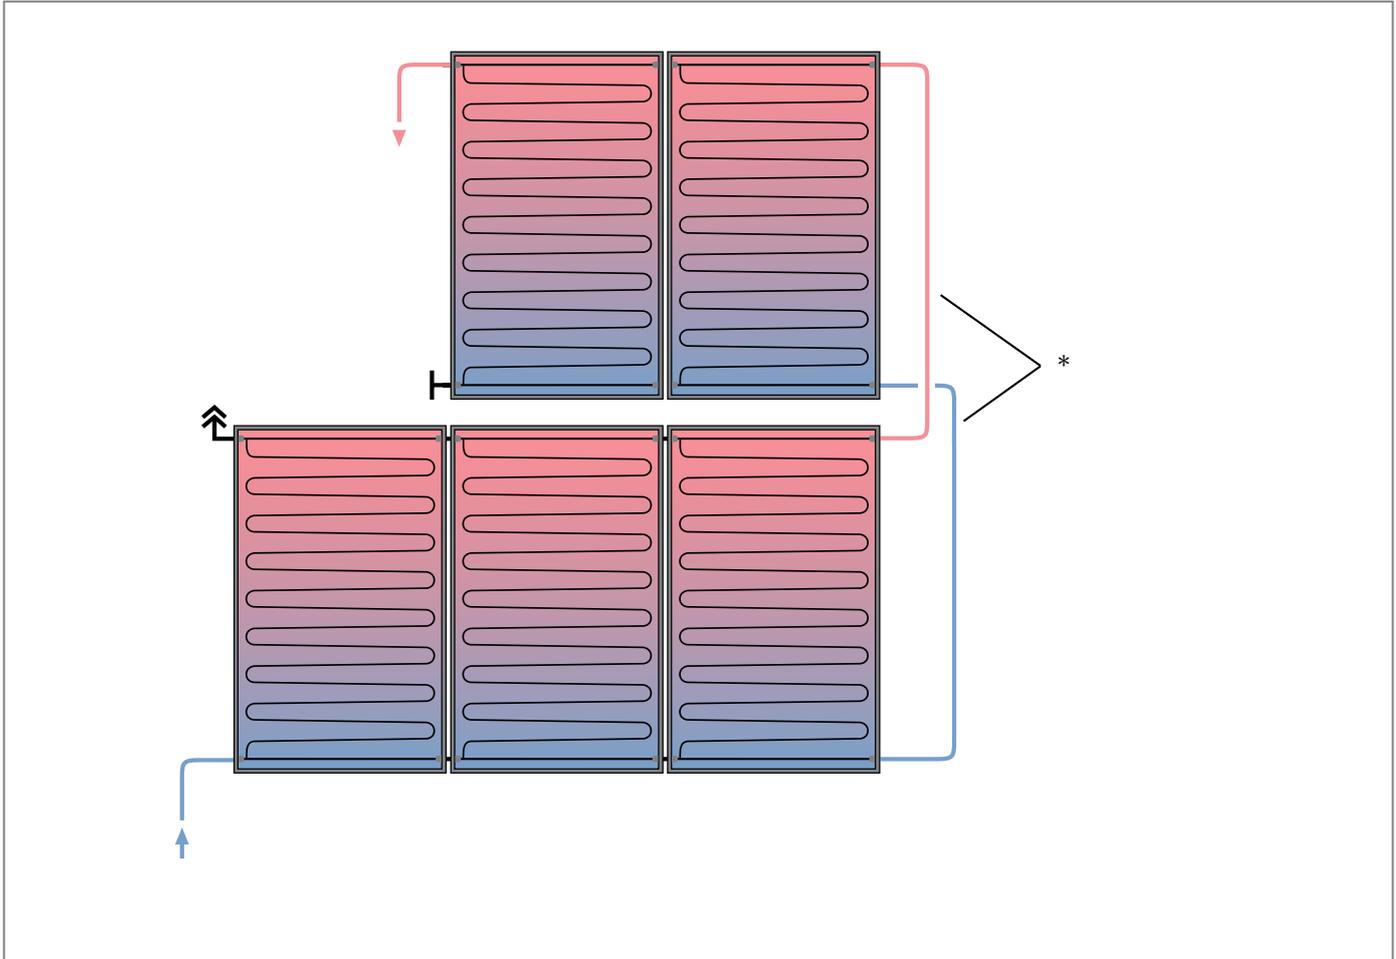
Schema dei collegamenti con 5 collettori su due file e tubazione sul posto
